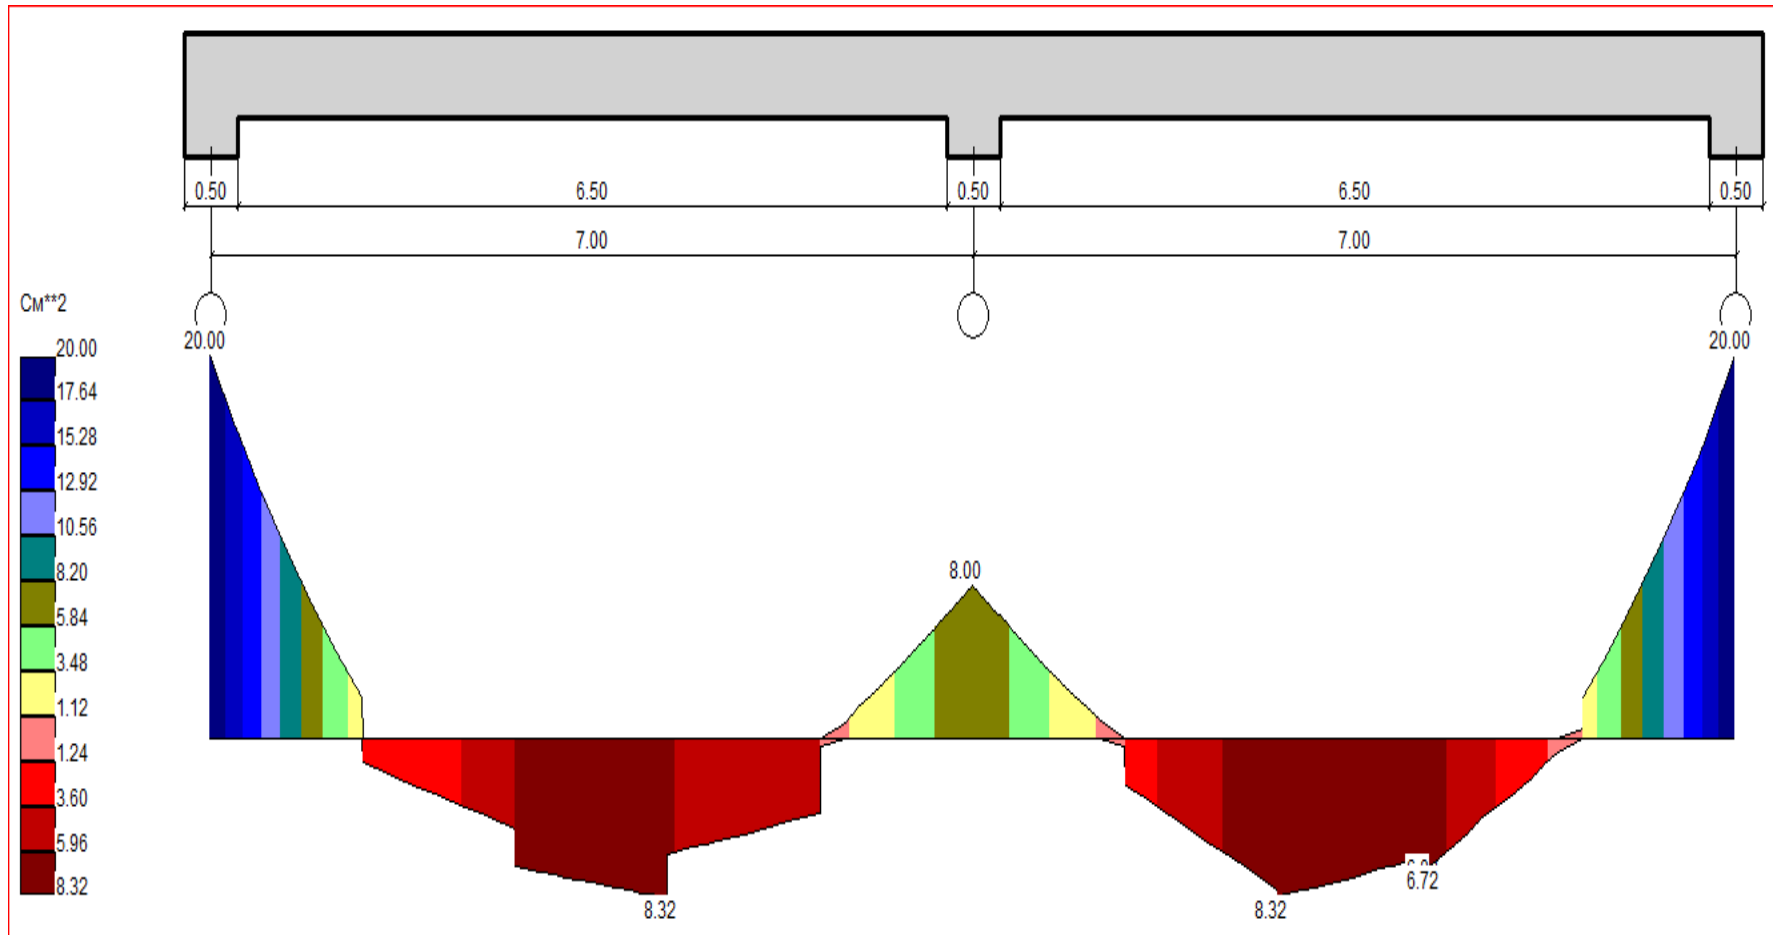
Варіант балково-плитного перекриття. Балка Б9-9. Епюра подовжнього теоретичного армування
